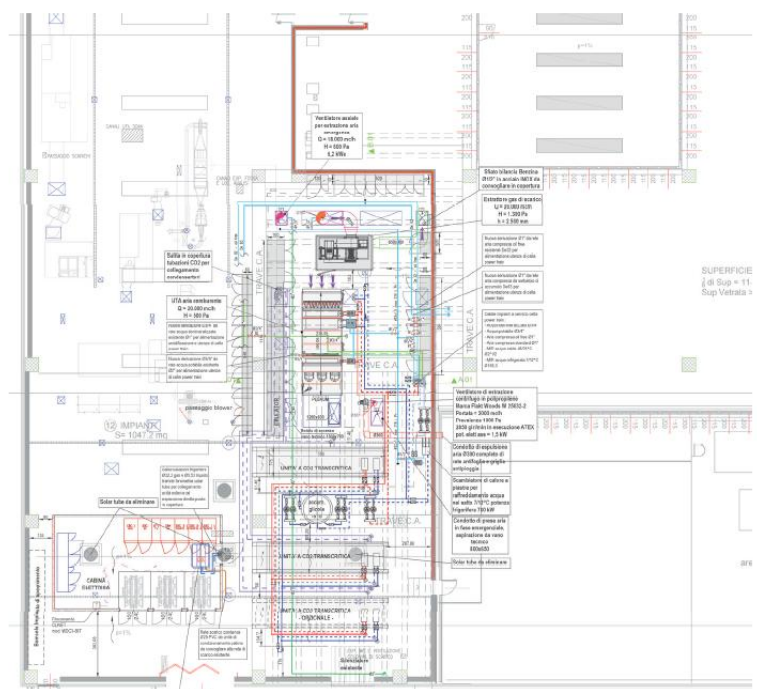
Planimetria Piano primo (locale tecnico)
